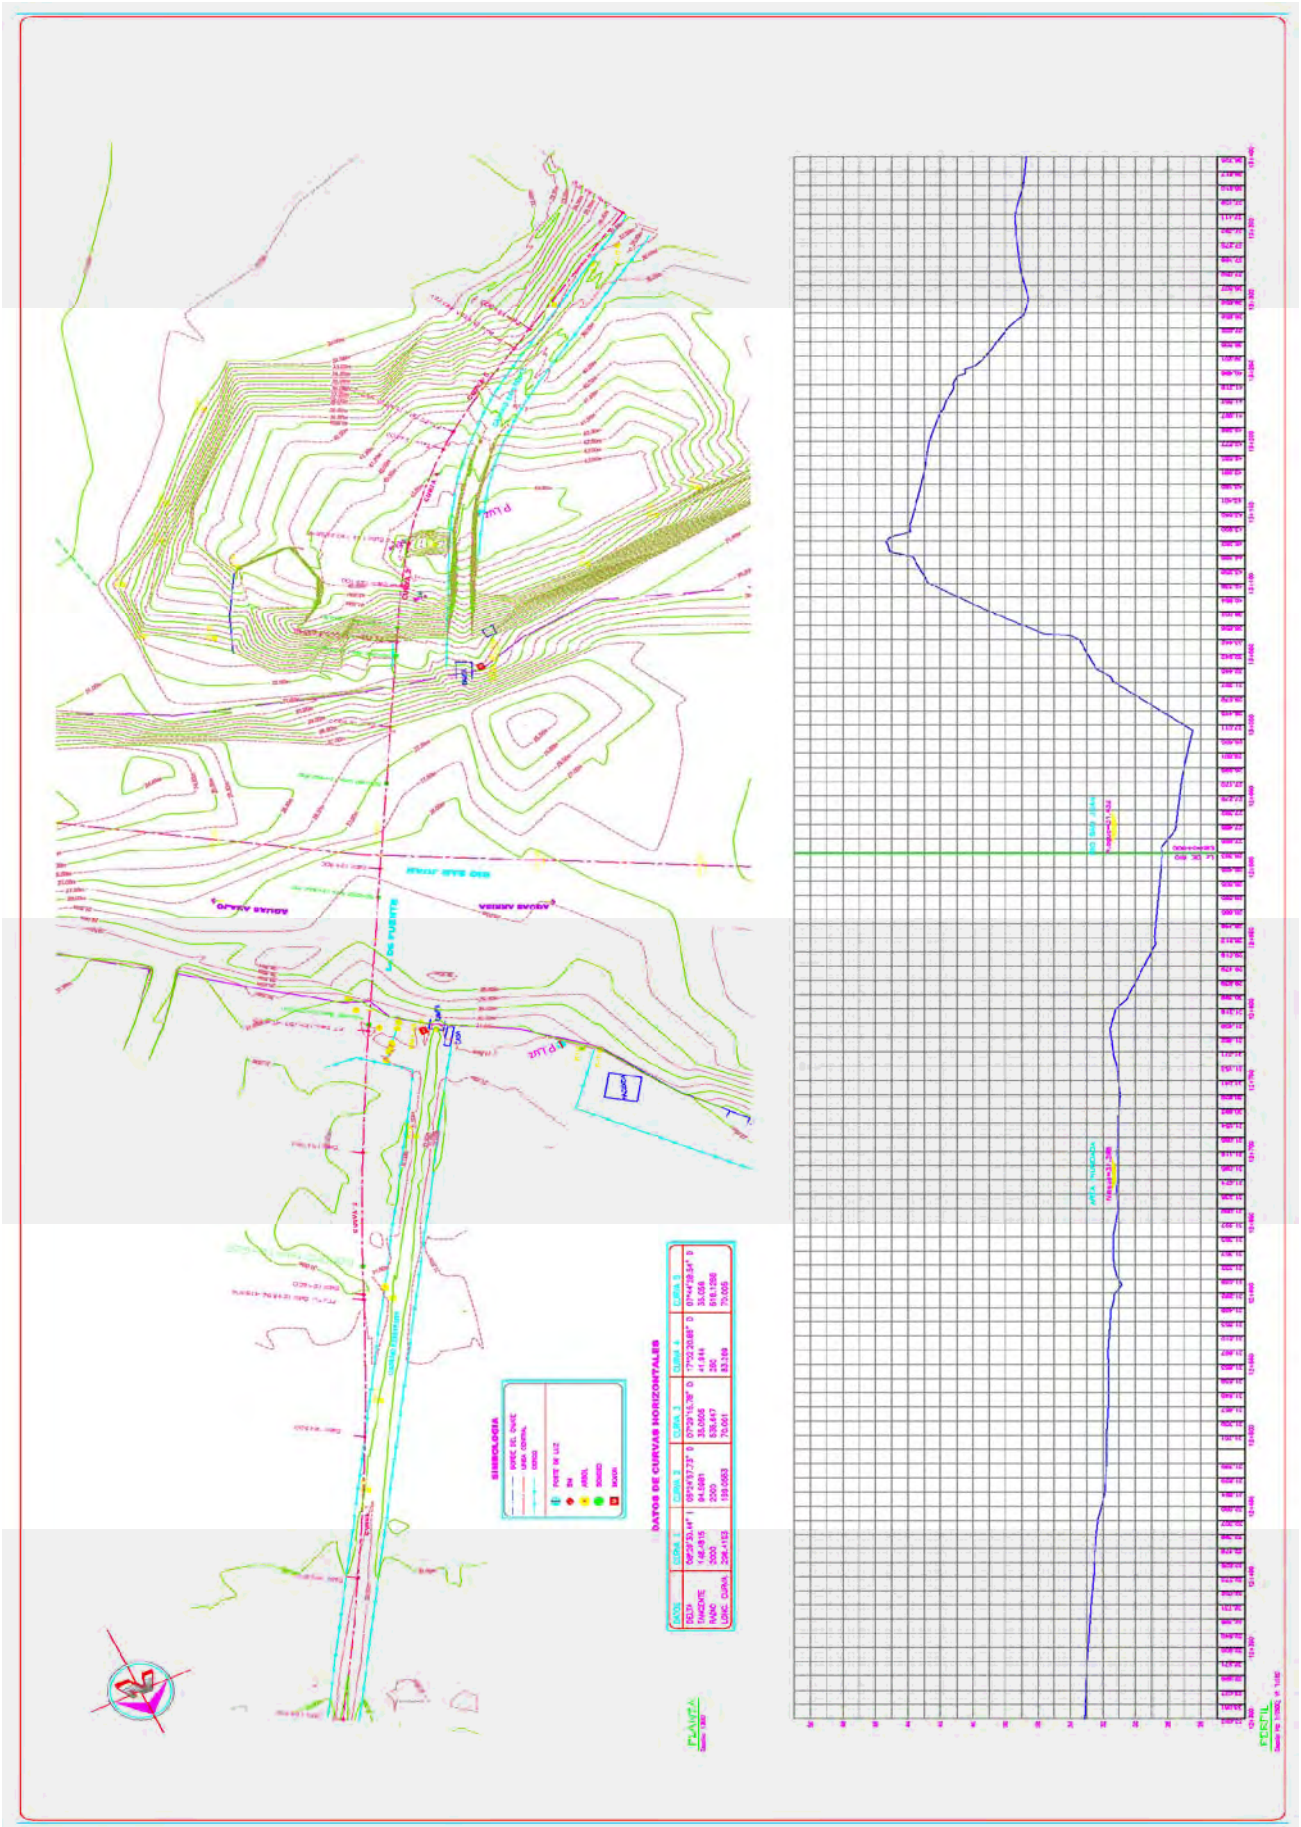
Plano de Levantamiento Topográfico y de Corte Longitudinal
